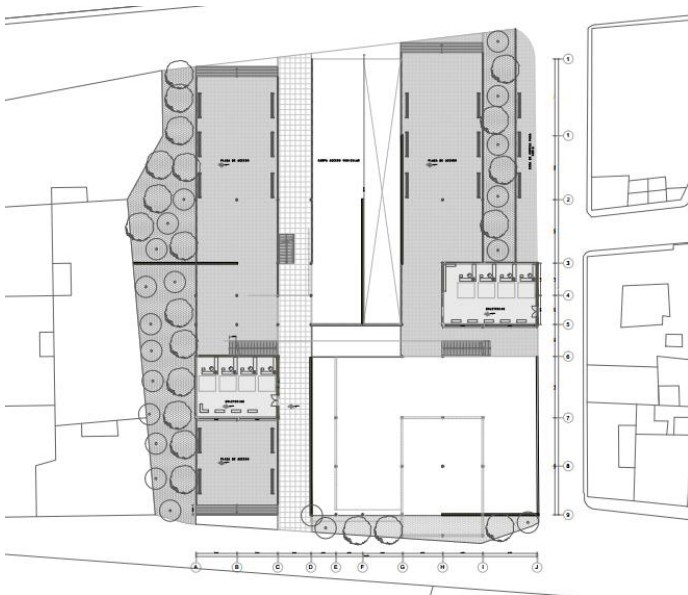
Planta Primer nivel (Sanchez J. D., 2018)
